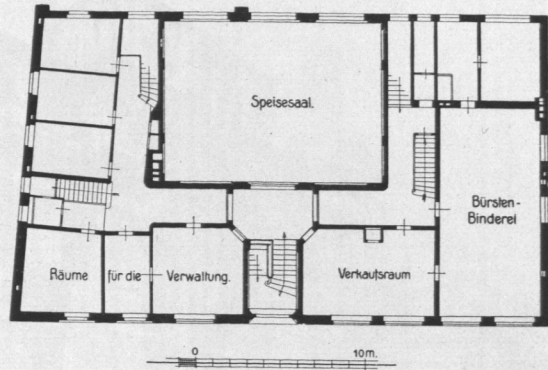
Blindenanstalt, Erdgeschoß, Grundriß.
